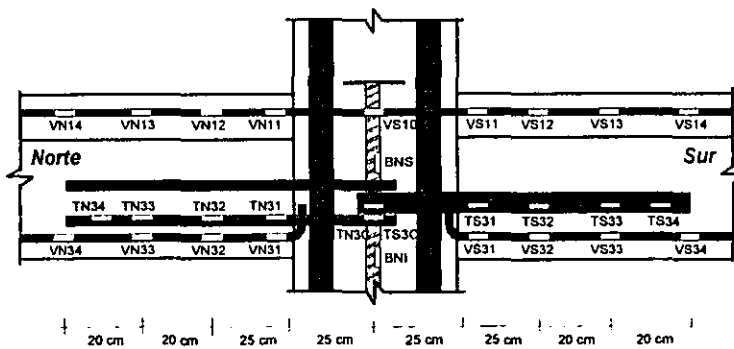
Instrumentación interna de las vigas de rigidez
